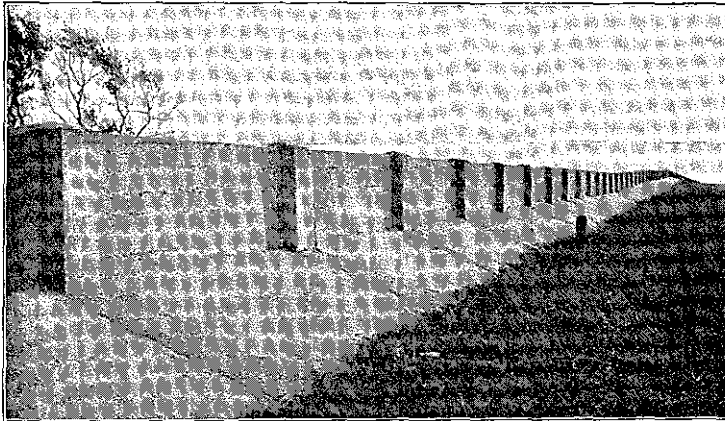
Betonconstructie van Owens en Case met voetplaat (Polder Soelekerke)
